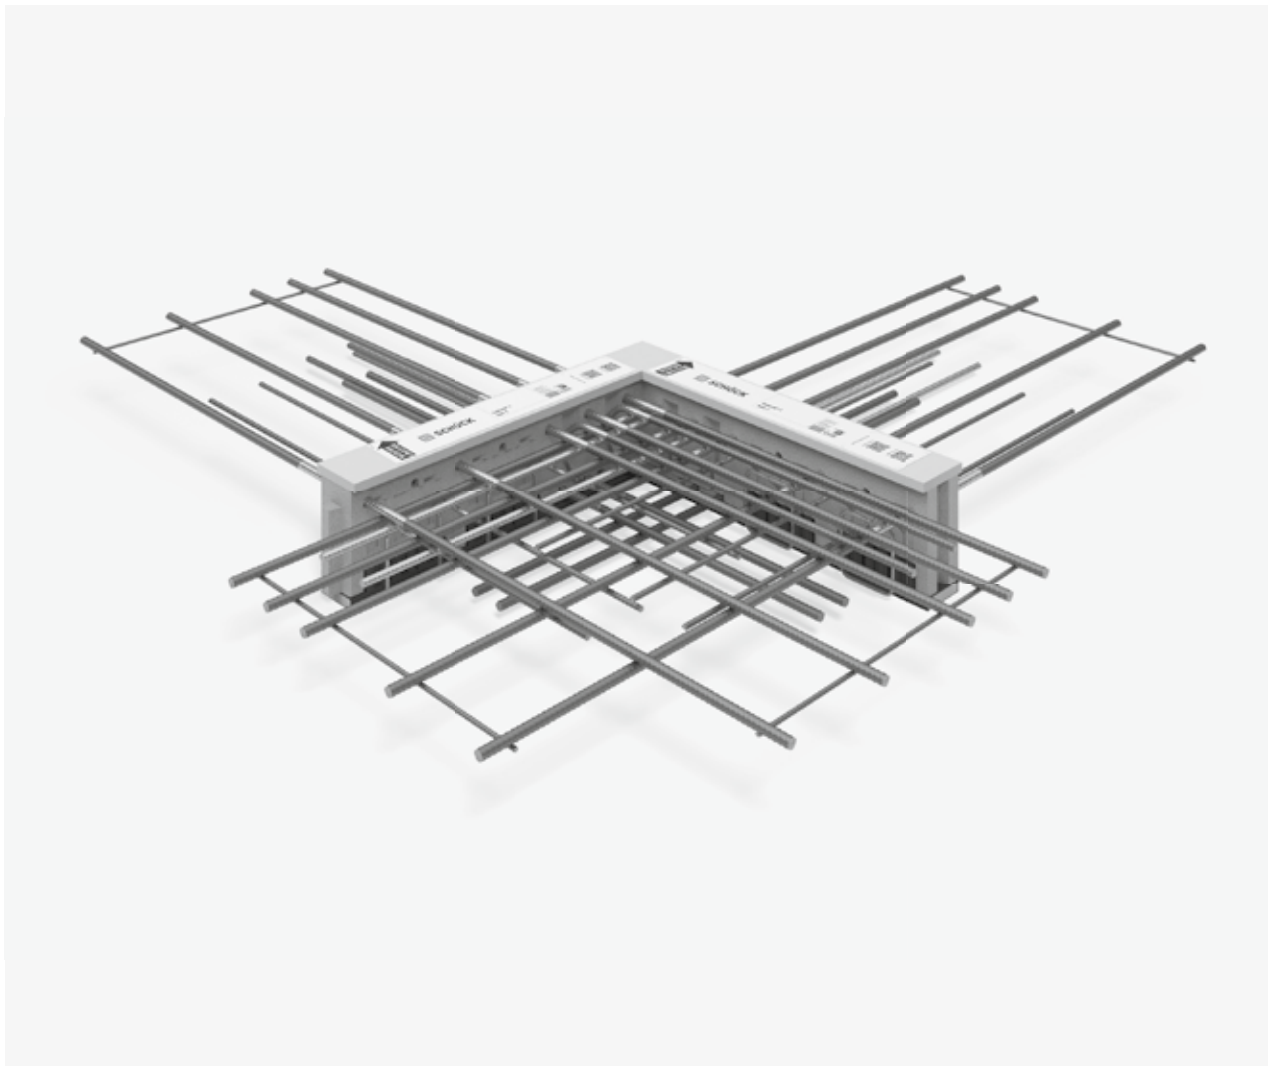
Schöck Isokorb® T tipo Q-P: Se requiere apuntalamiento continuo
